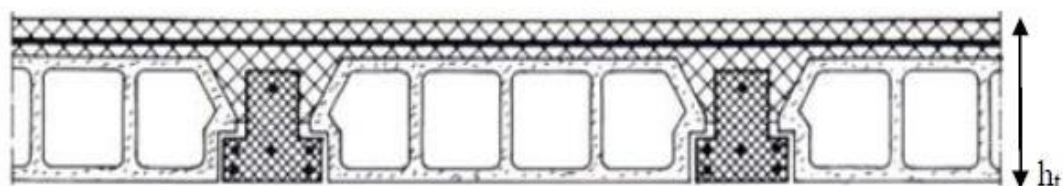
Coupe transversale d'un plancher à corps creux.
